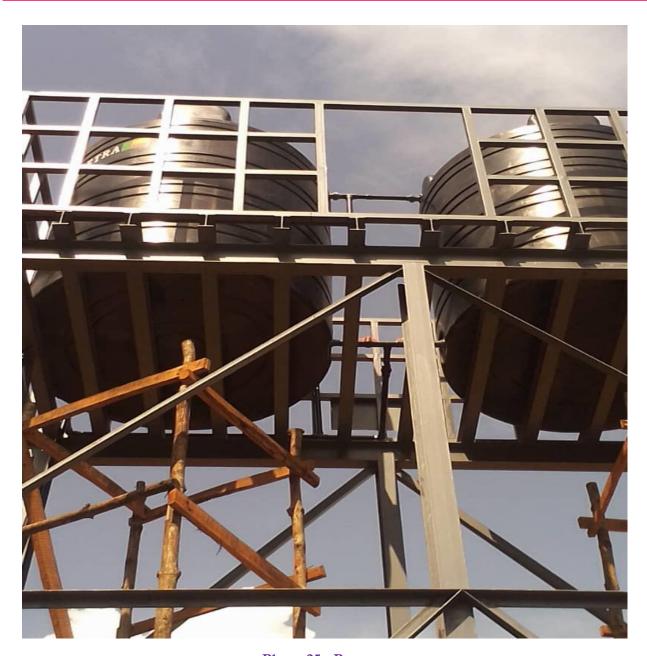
Poutres et pannes Source: YAROU ISSA K.
